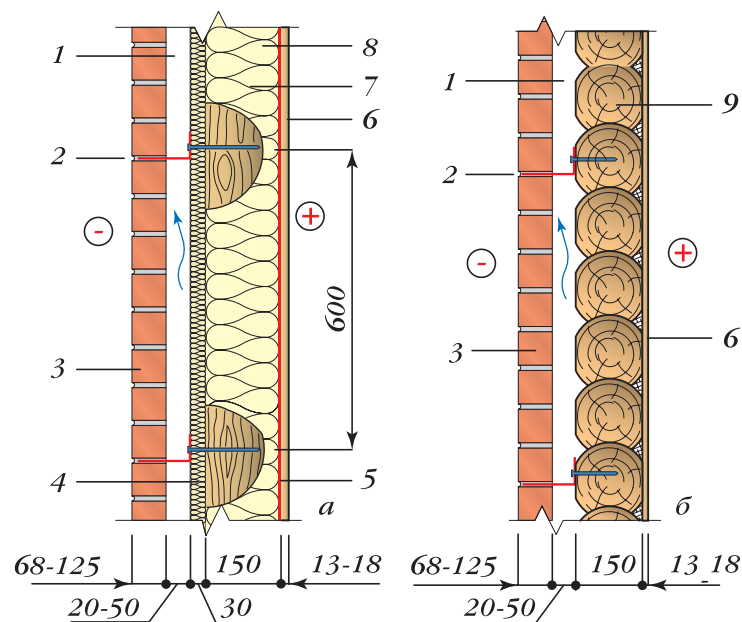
Пример обмуровки деревянных стен (размеры в мм): а — каркасных утепленных с применением ветроизоляционной плиты; б — рубленых без утепления; 1 — вентилируемая воздушная прослойка; 2 — деталь крепления; 3 — кирпичная кладка; 4 — ветроизоляционная утепленная плита, например, PAROC WAS-25, WAS-35; 5 — пароизоляция; 6 — отделка; 7 — каркас; 8 — утеплитель; 9 — рубленая стена
